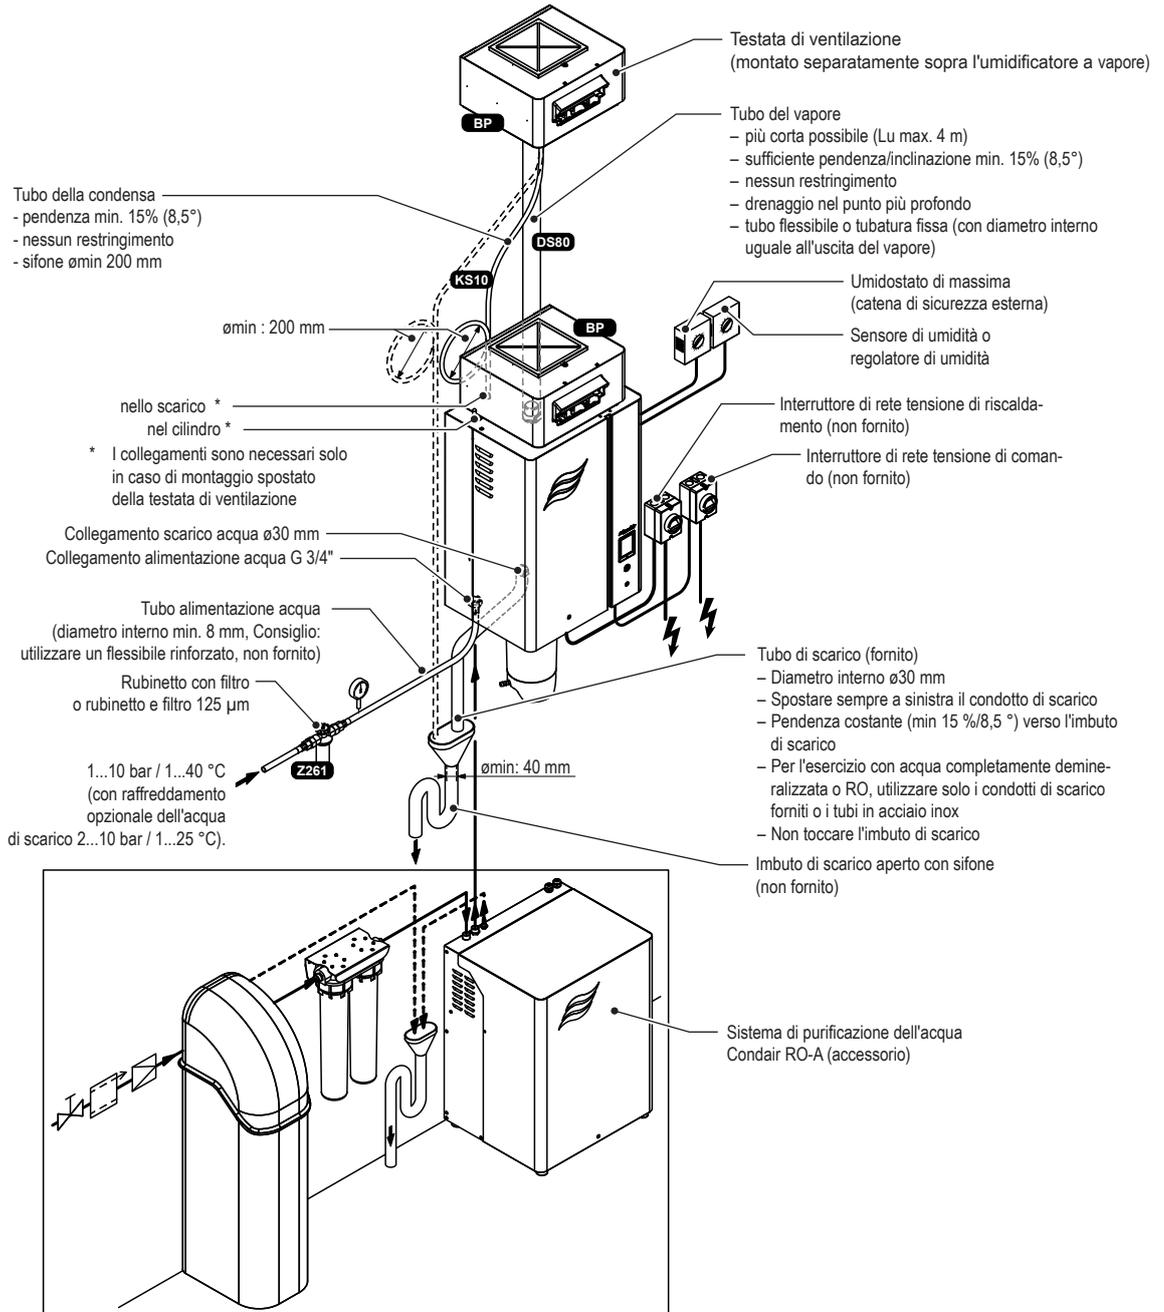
Installazione tipica per l'umidificazione diretta in ambiente
